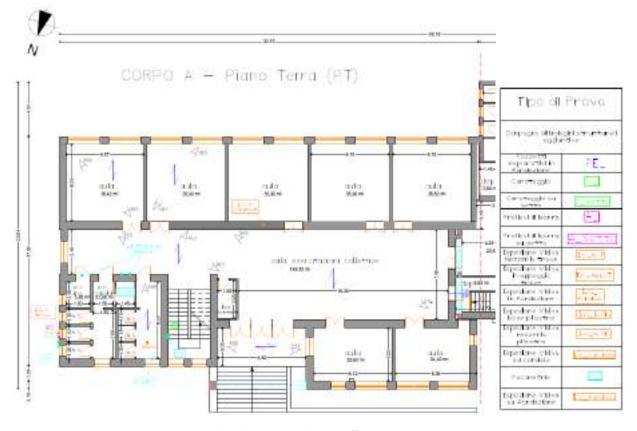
Planimetrie strutturali con localizzazione delle prove effettuate in sito - Pianta Piano Terra - Corpo A - Campagna di indagini strutturali 2023
